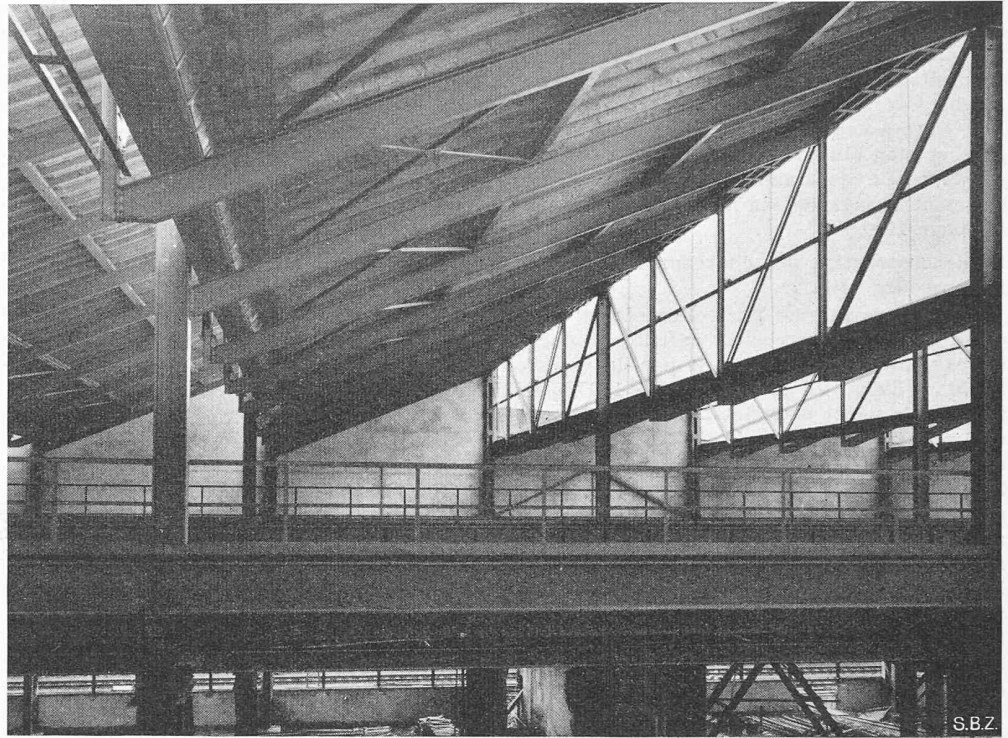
Innenansicht der gedeckten Hallen vor dem Anbringen der Dachisolation
